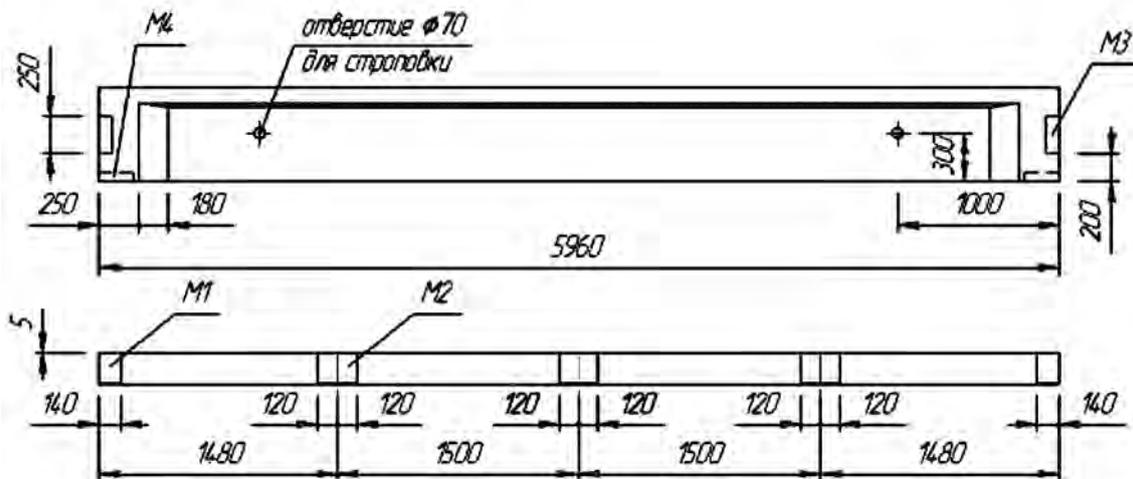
Маркировка закладных деталей на опалубочном чертеже железобетонной стропильной балки БСП6 (М1, М2 — для крепления ребристых плит покрытия, М3 — для крепления панелей наружных стен, М4 — для крепления стропильной балки к колонне)
